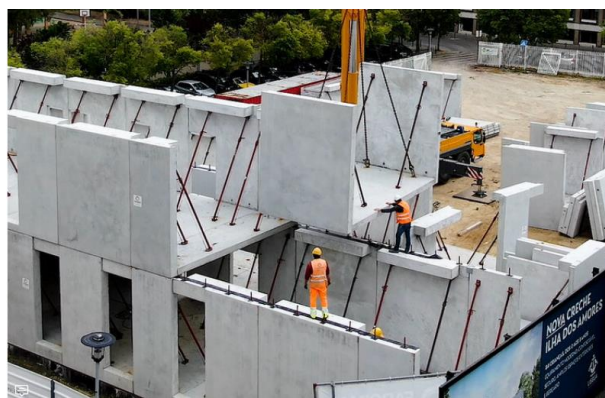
Montagem de painéis prefabricados com o auxílio de contraventamento (adaptado de [17]).
